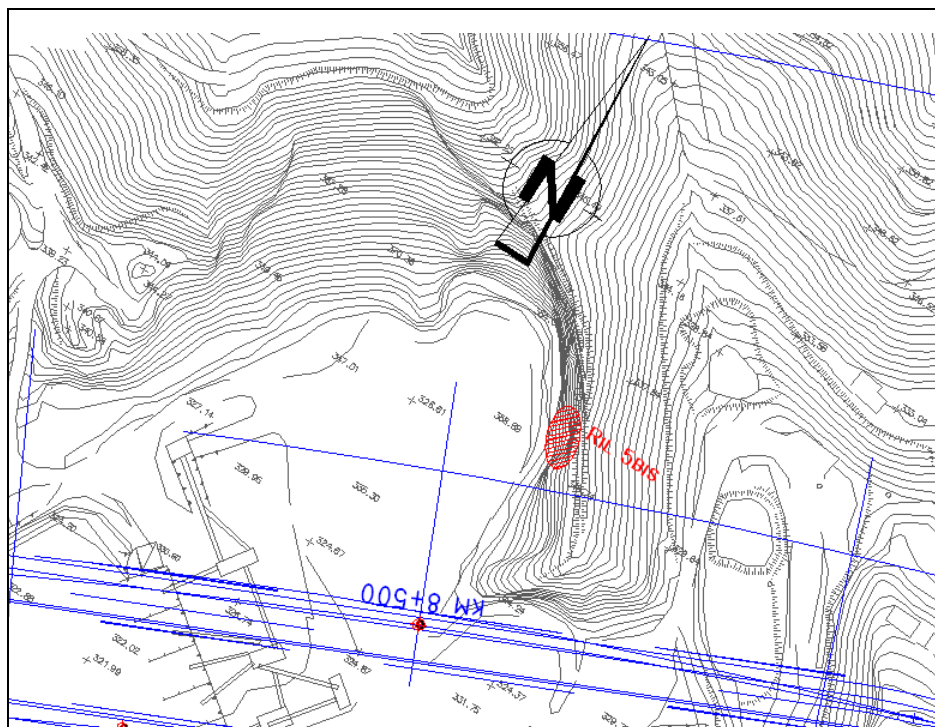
Ubicazione in planimetria dell'affioramento oggetto del rilievo geostrutturale
